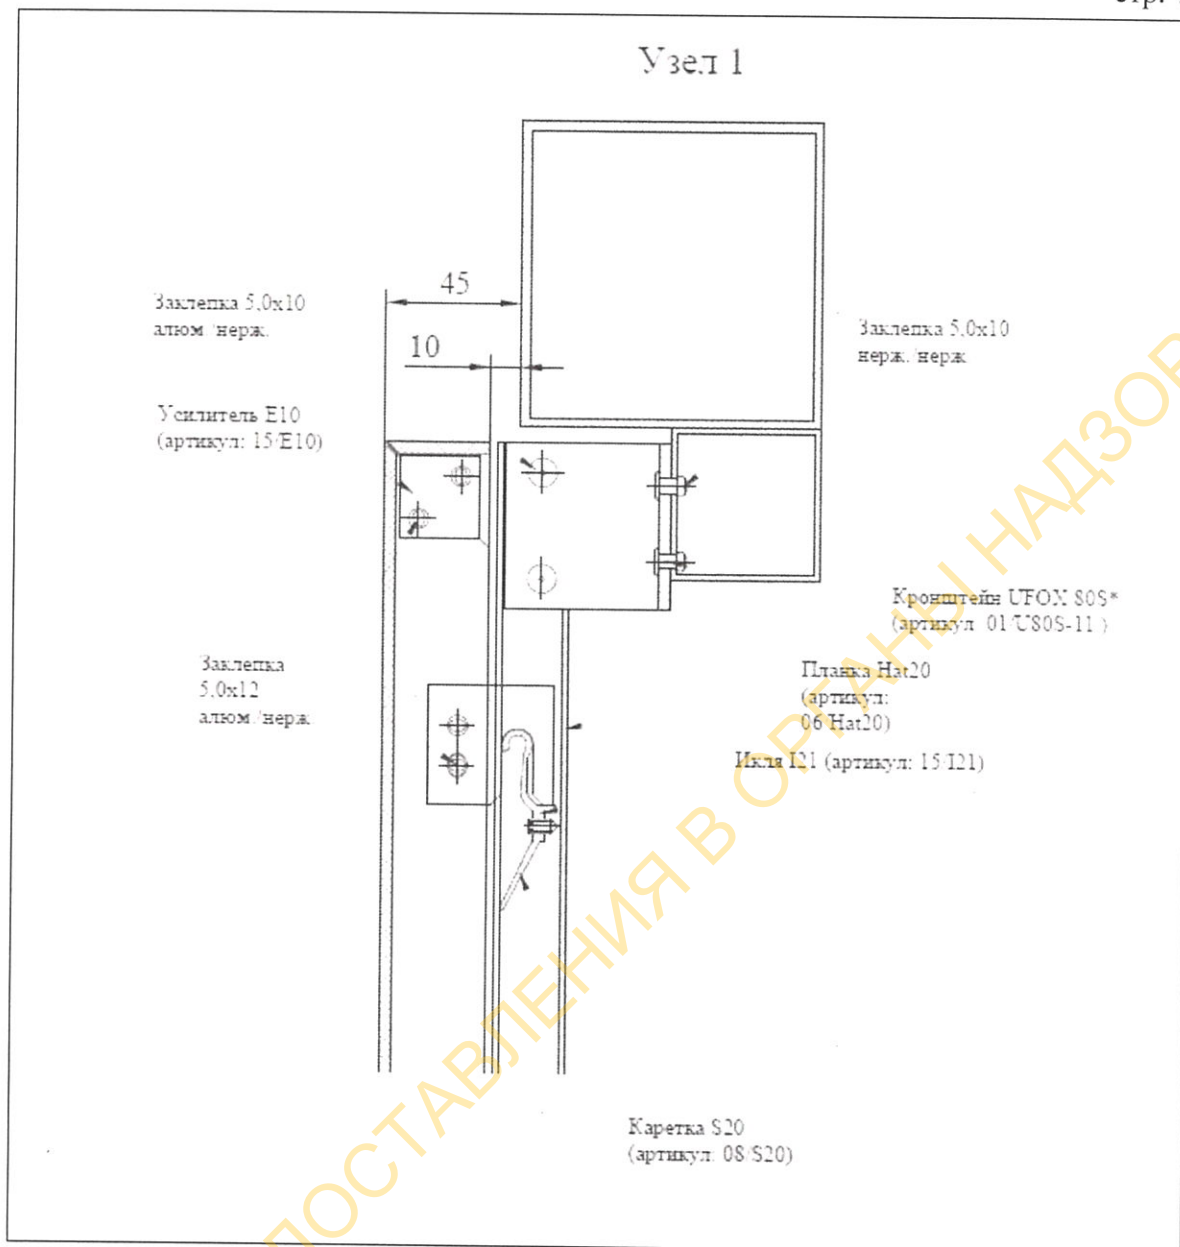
Испытуемый образец 1134-24. Узел 1
